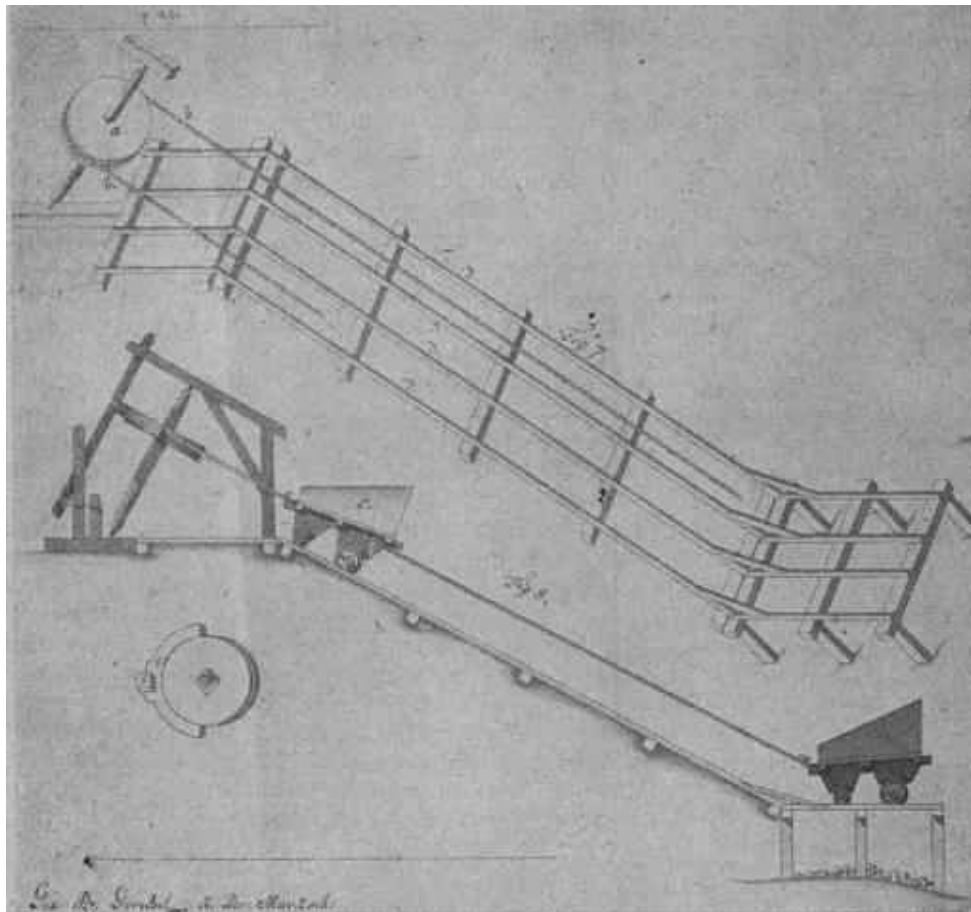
Instalația de la Săcărâmb pentru transportul minereului pe un plan înclinat
